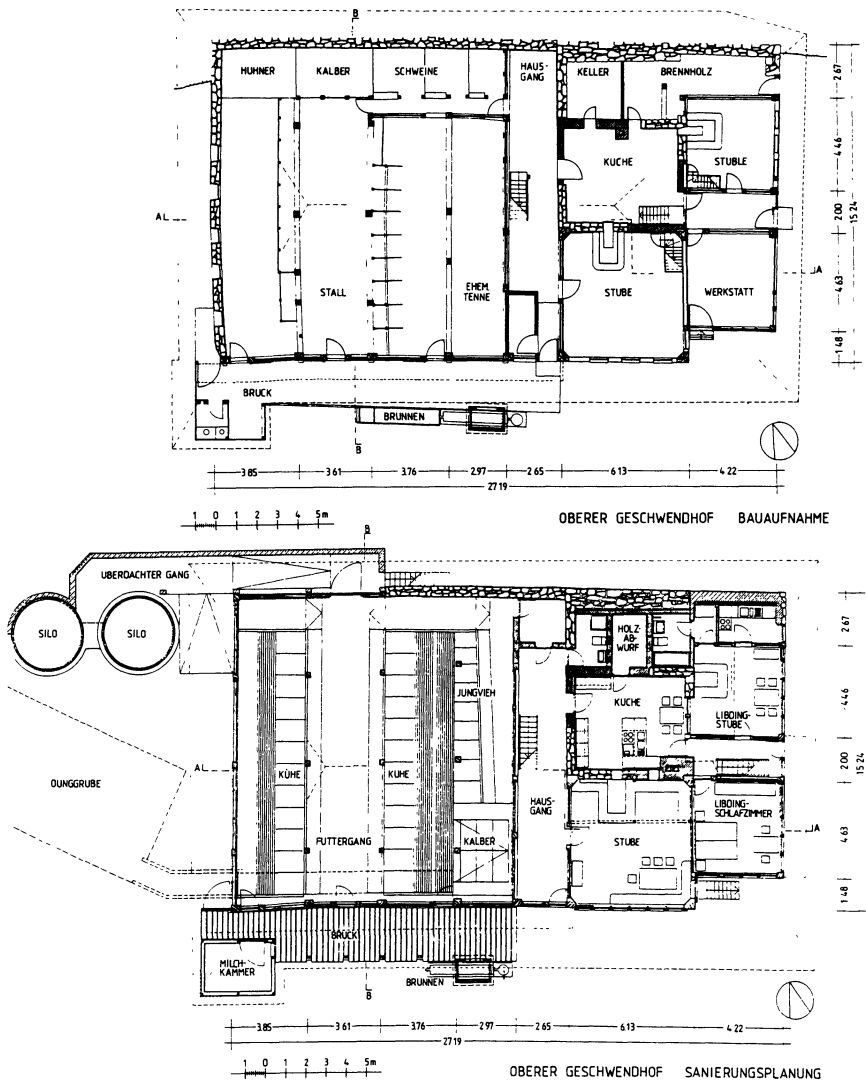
Oberer Geschwendhof, Grundriß Erdgeschoß; oben: Bauaufnahme, unten: Sanierungsplanung.
